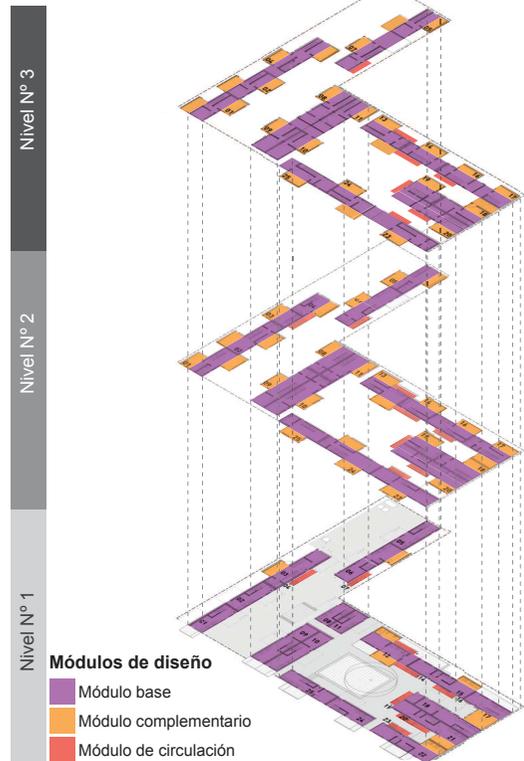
Plantas Centre Village. Adaptado de Archdaily 2013
